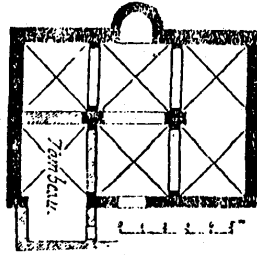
مسقط أفقي لمشهد الجيوشي بالمقطم بالقاهرة (عن : صالح لمعي) .
